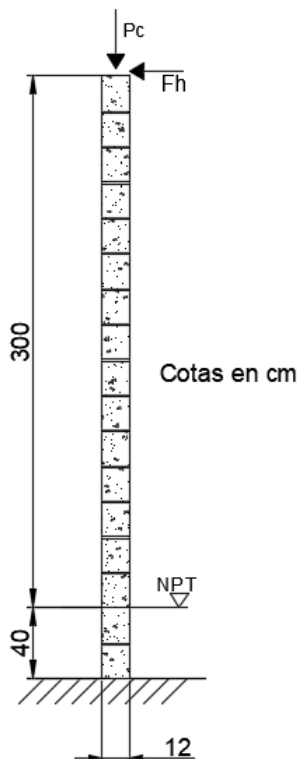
Vista frontal de la columna de mampostería, con las fuerzas aplicadas
